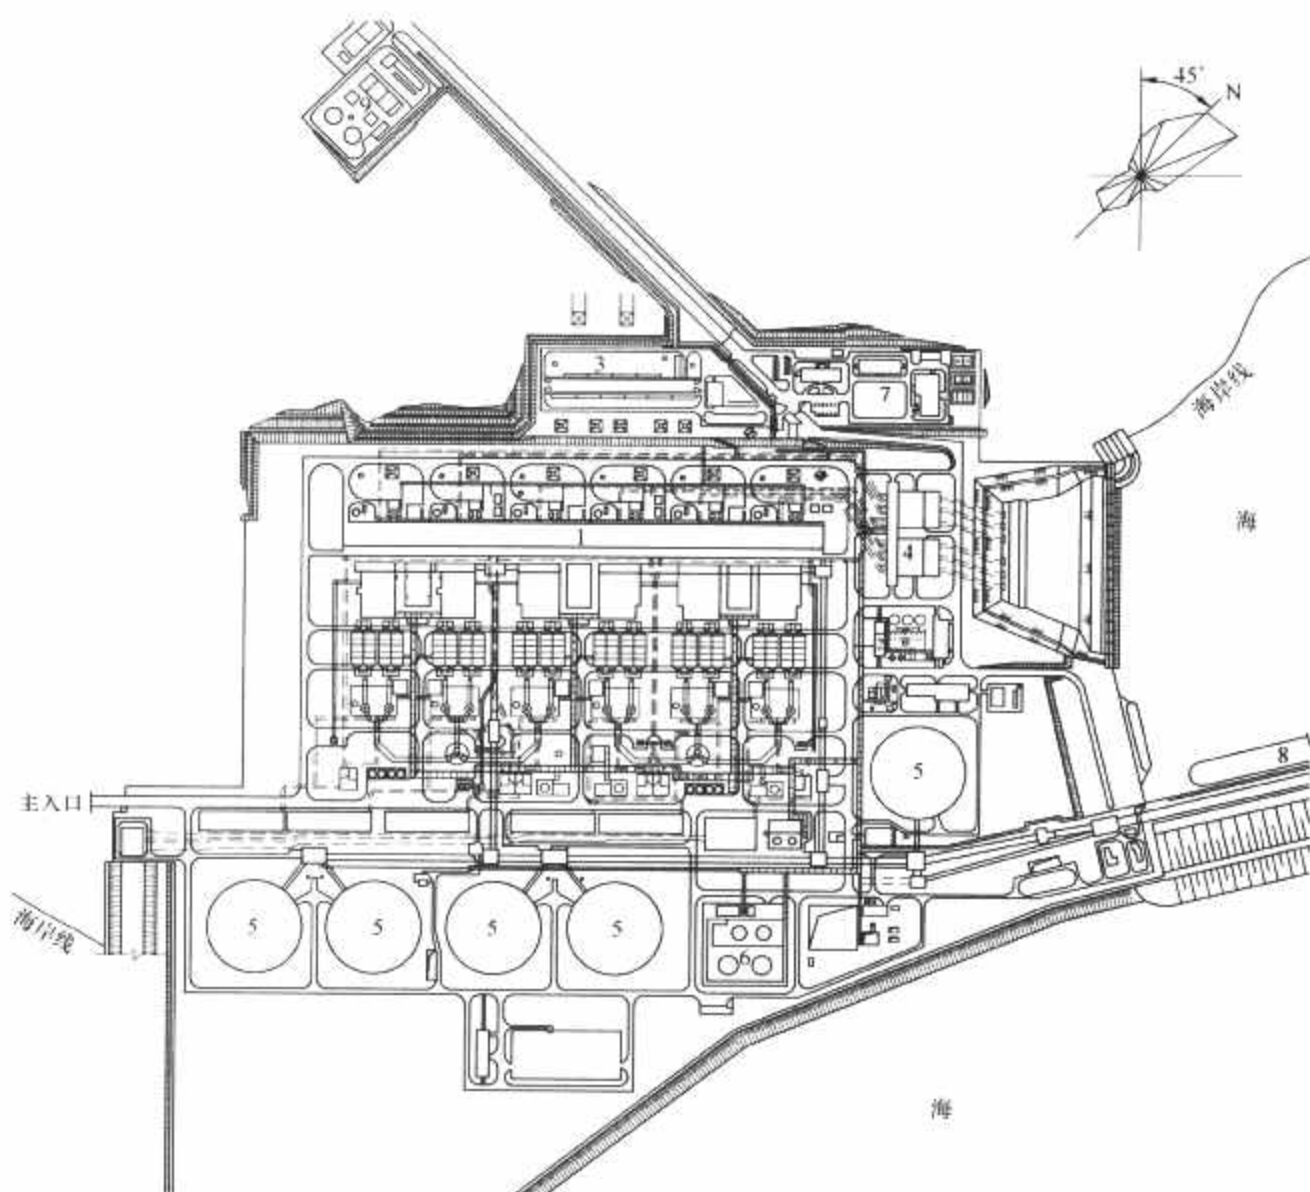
主厂房固定端朝向水源的三列式电厂总平面布置图
